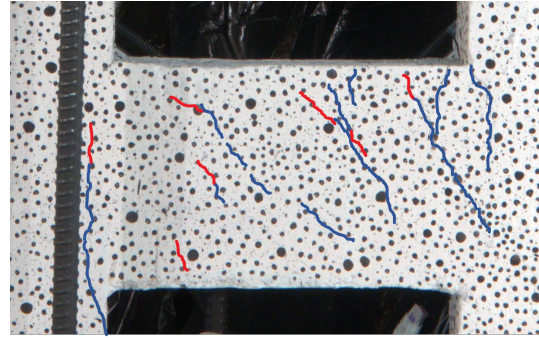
Grietas Vigas a 0.6 % Drift
